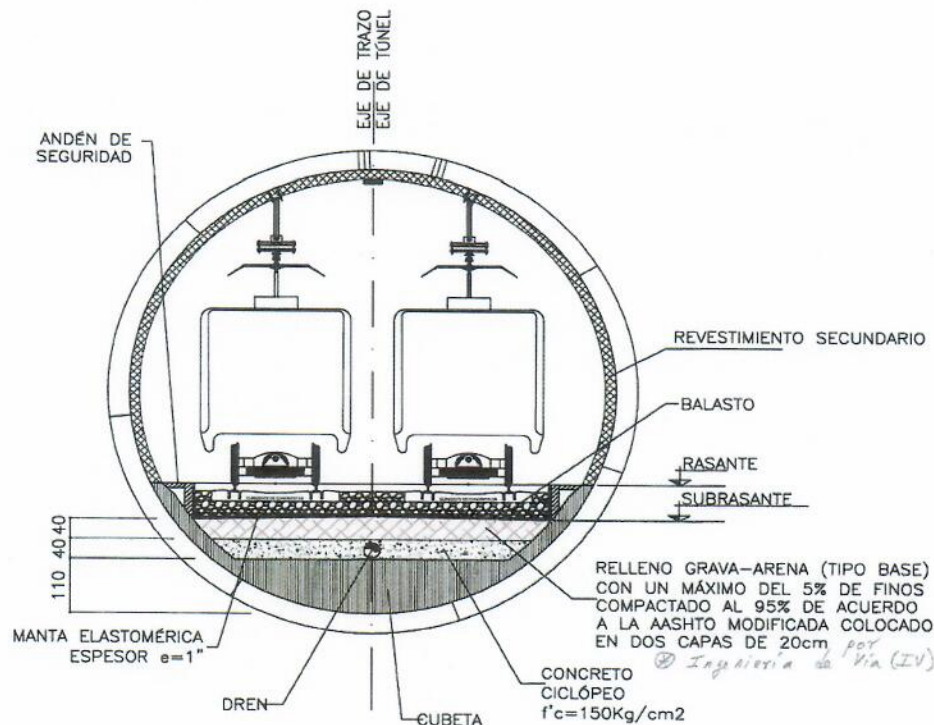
Sección transversal construida en la zona A (PMDF-11-EST-612000-III-0240-51298-P-00).
